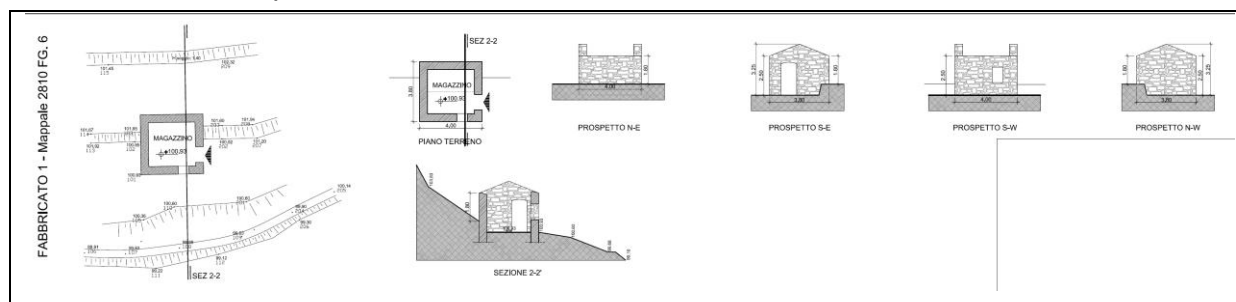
Stato attuale da progetto autorizzato con PdC 896/2021
